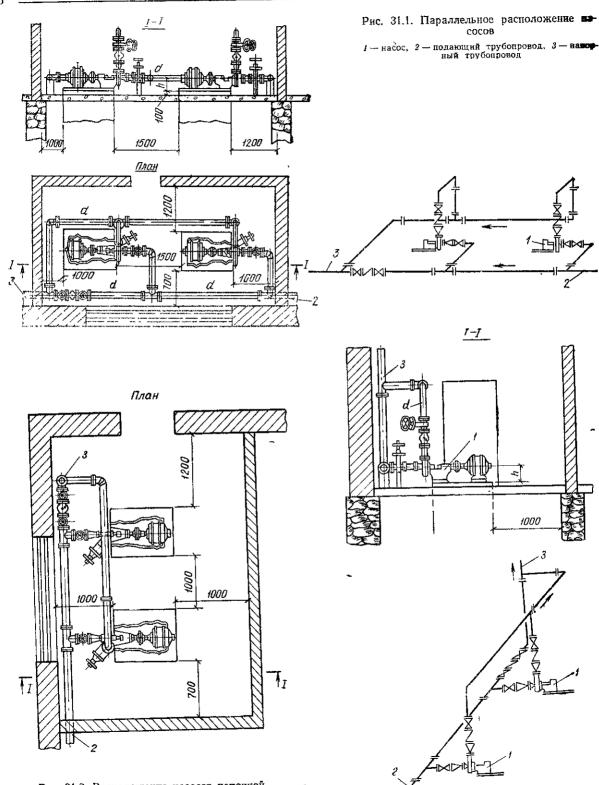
Расположение насосов цепочкой -- насос: 2—подающий трубопровод. 3—напорный трубопровод
